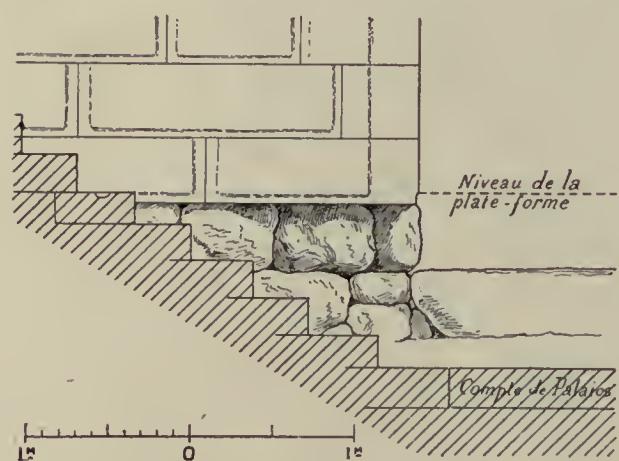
Marches inférieures de l'escalier du théâtre.
